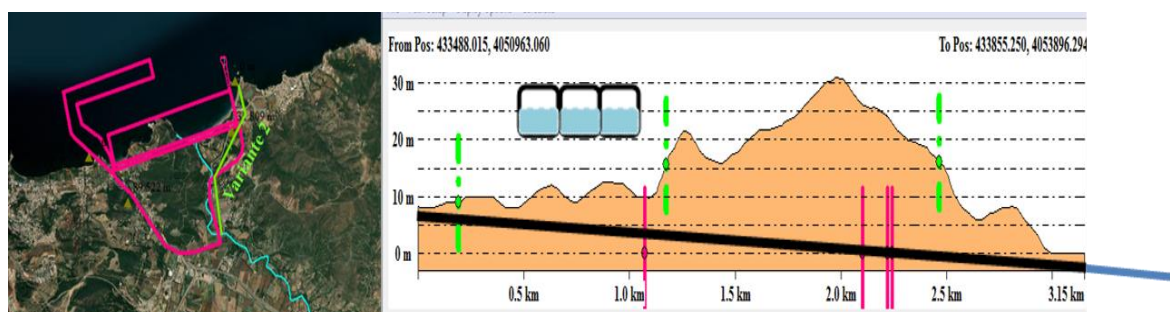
Vue en plan, profil en long et section en travers de la variante 2
